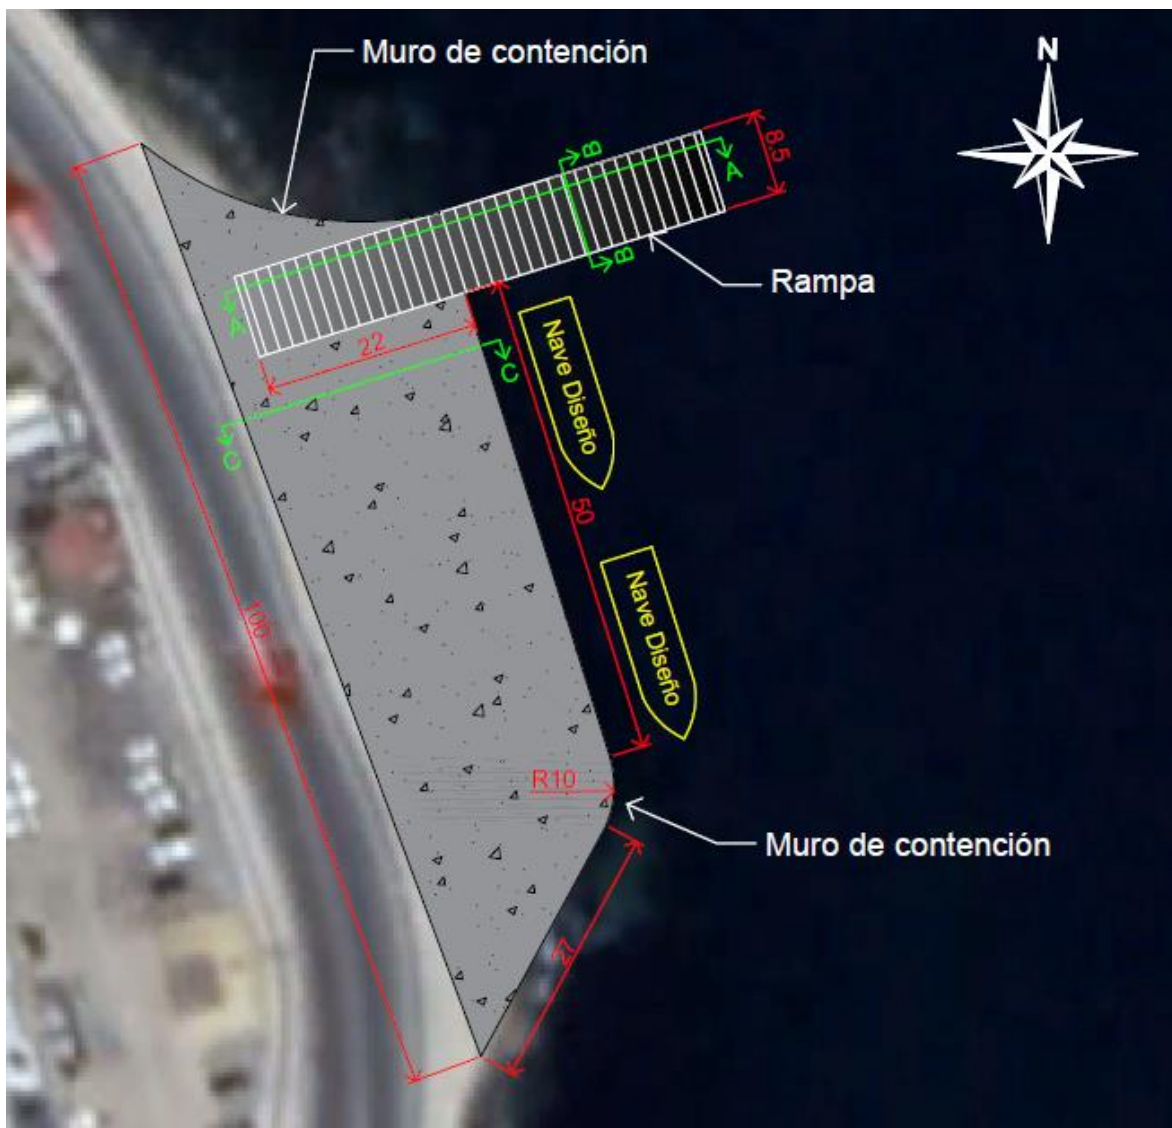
Diseño en planta. Fuente: Elaboración propia con Autocad.
